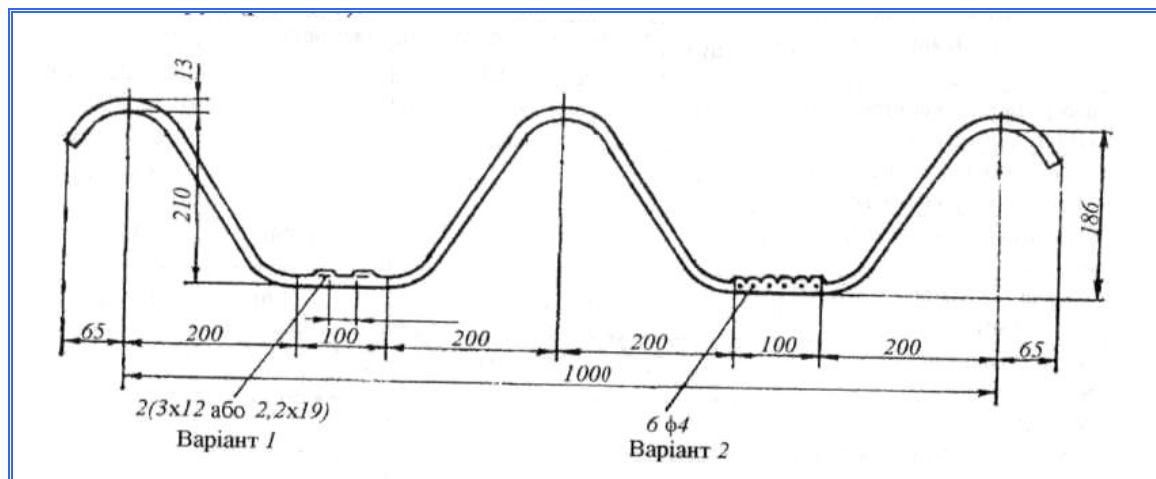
Поперечний переріз азбестоцементного армованого настилу
